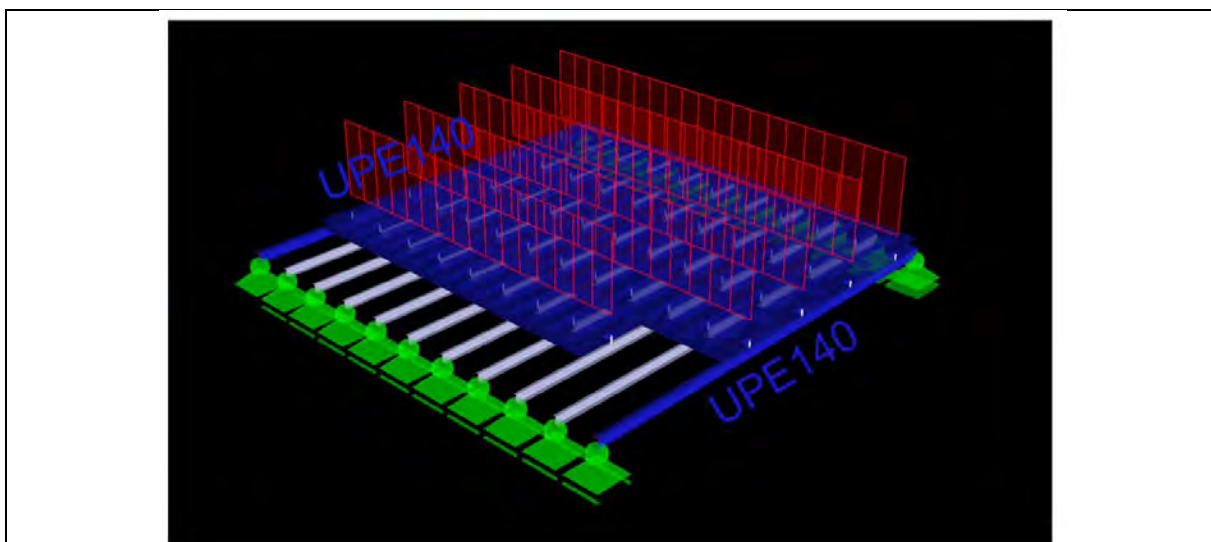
Stabwerksmodell Fassadenabschnitt 6000 x 6000 mm mit UPE 140 im Sockel- und Traufbereich
